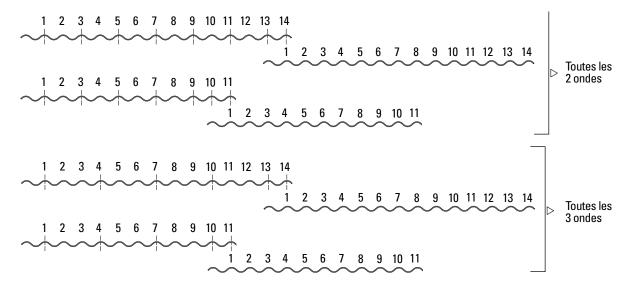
Implantation des fixations aux recouvrements sur une couverture en tôles ondulées de 14 et 11 ondes
